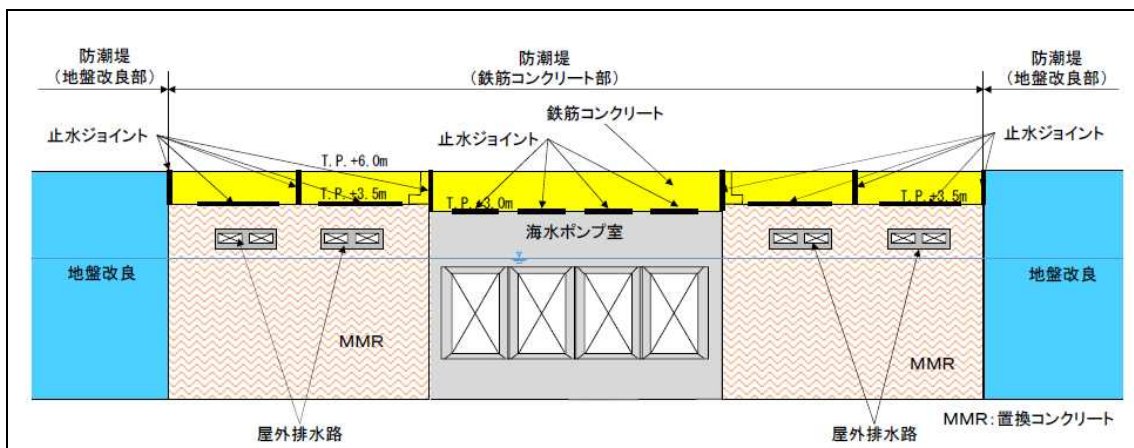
鉄筋コンクリート部 正面図 (関西電力 美浜3号炉)
